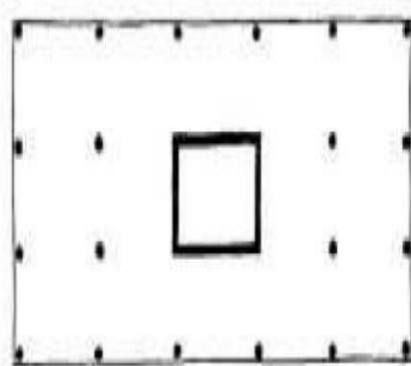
Vue en plan d'un bâtiment à Noyau de stabilité [22].
